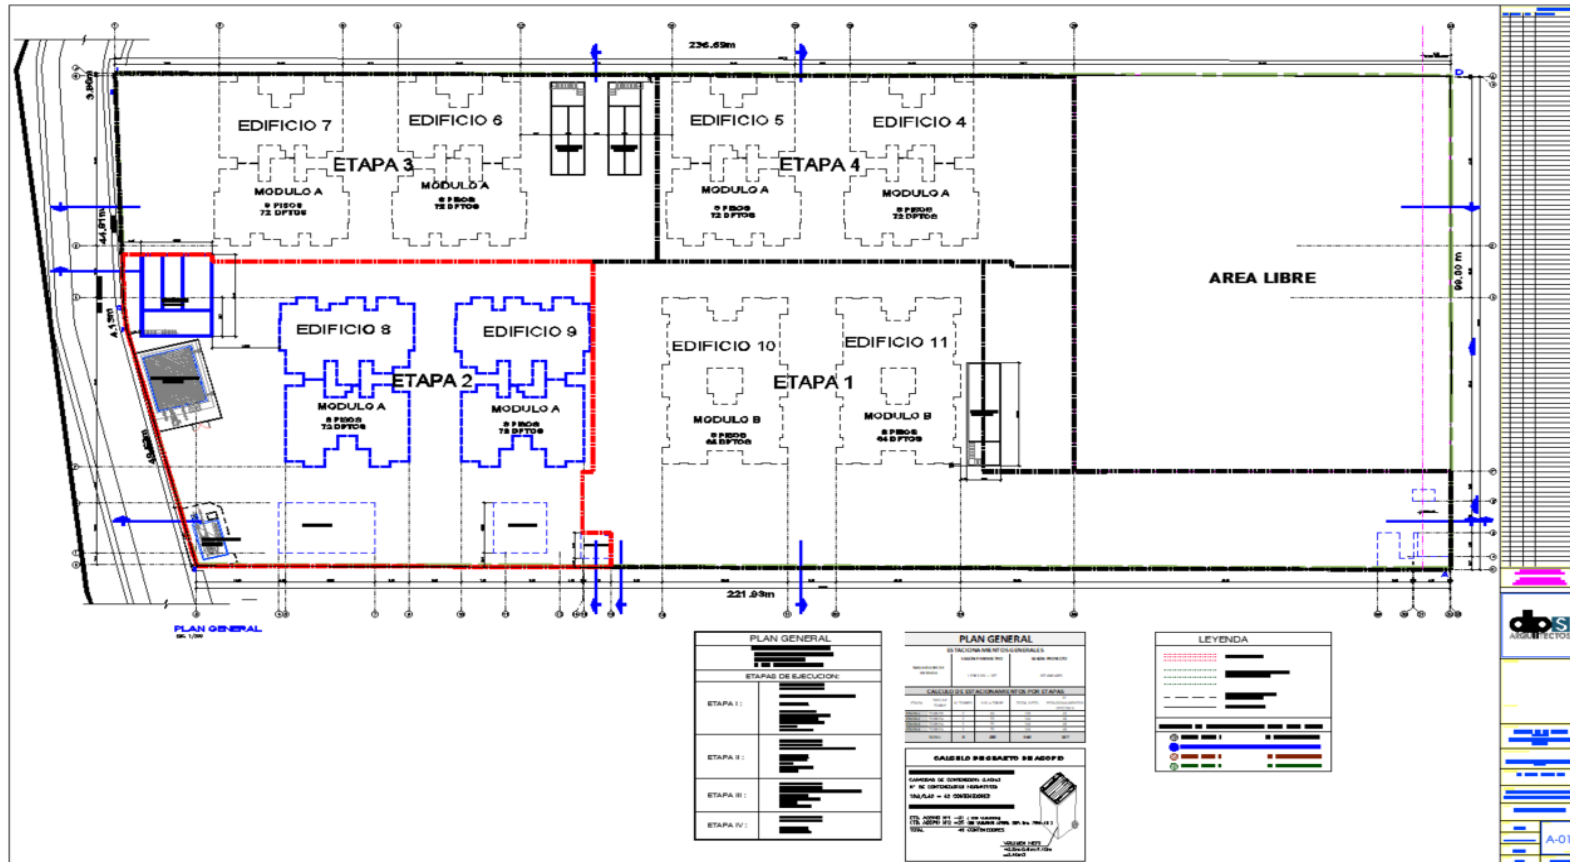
Plano de Planta Condominio la Ribera de Santa Clara
